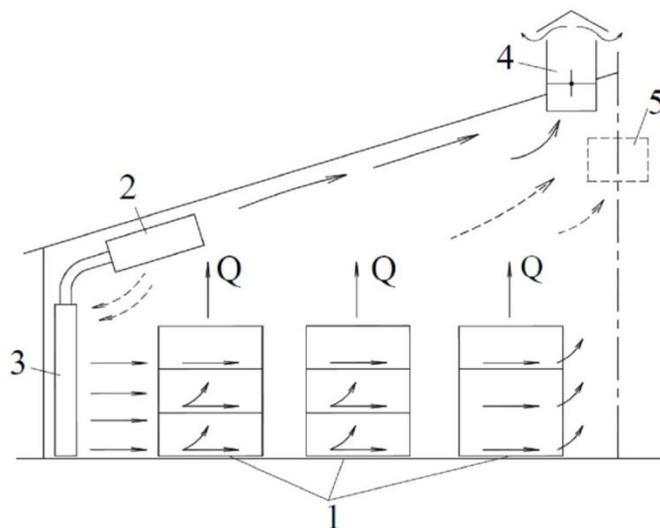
Схема организации воздухообмена в помещении птичника: 1 – клетки с курами; 2 – приточный воздуховод от центральной приточной установки; 3 – ЭВУ; 4 – вытяжная вентиляционная шахта; 5 – вытяжной воздуховод для работы системы вентиляции в холодный период года
